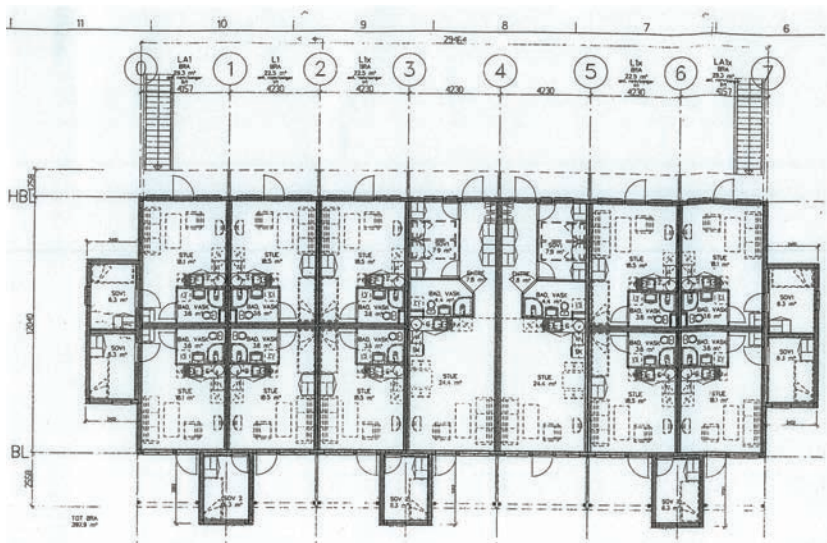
Planløsning for tre roms leilighet på 53 kvm.
